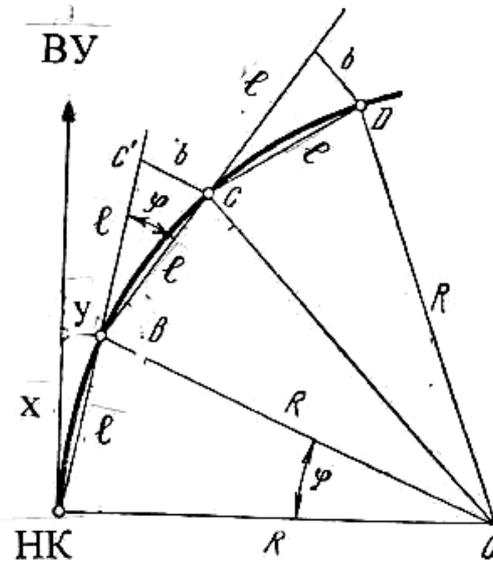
Детальная разбивка круговой кривой способом продолженных хорд
